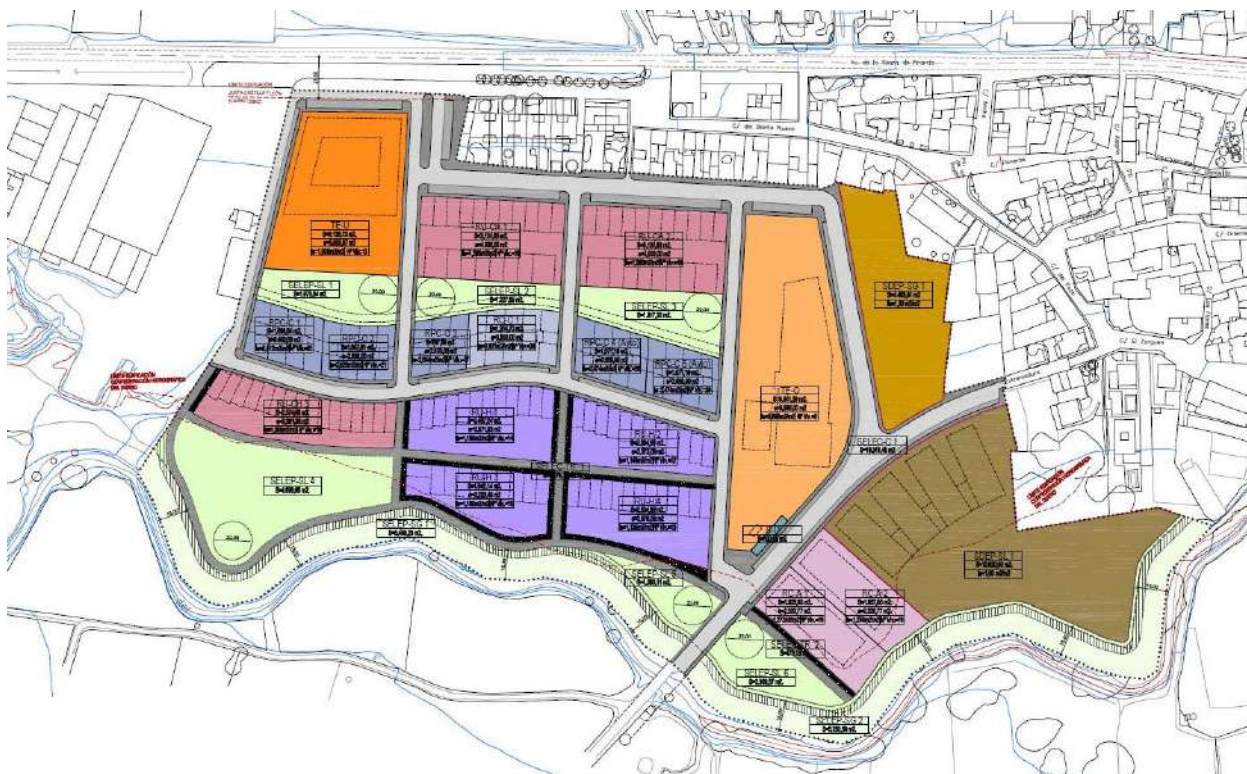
Plano de ordenación, calificación y usos. Plan Parcial 2010
